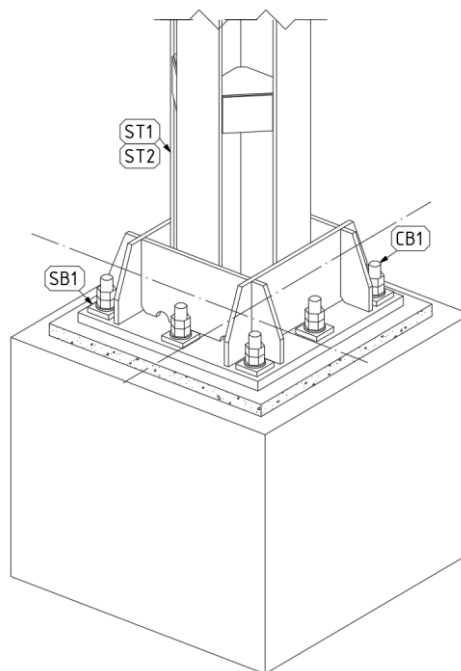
Detaliu conexiune stâlp metalic-fundație beton armat
